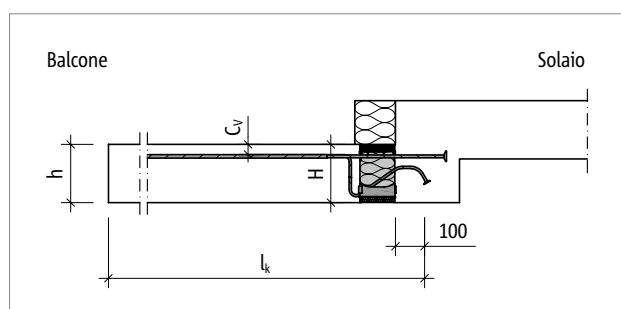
Schöck Isokorb® XT tipo KL-U: schema statico
